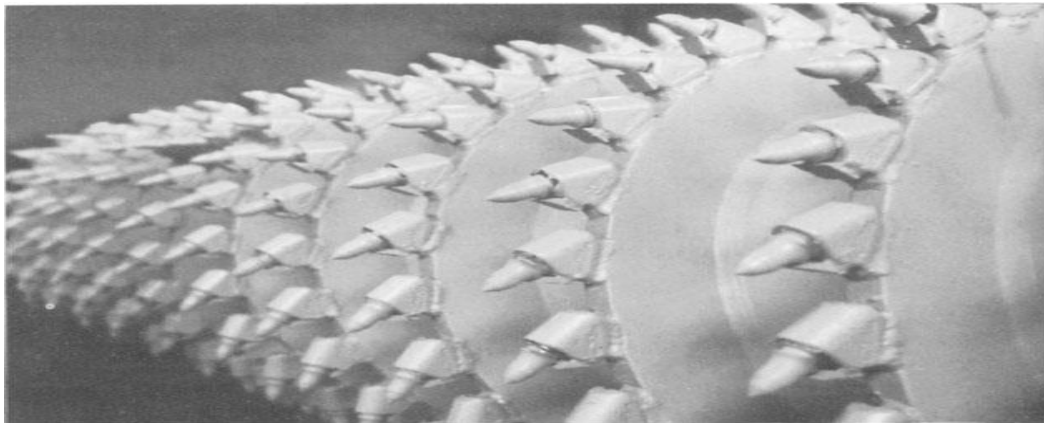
Outils à pointe en carbure montés sur un tambour rotatif d'une raboteuse[37].
